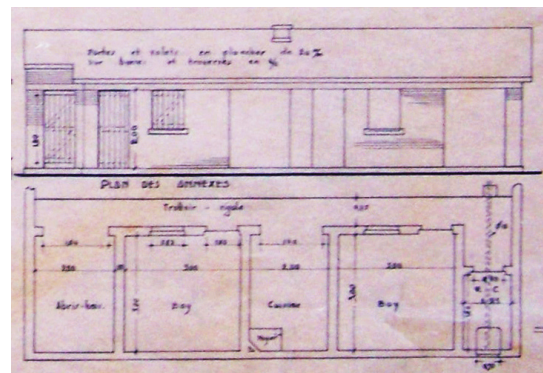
'Projet d'habitation à 3 chambres, Elisabethville. Plan des annexes. Plan de situation.', 1943.
